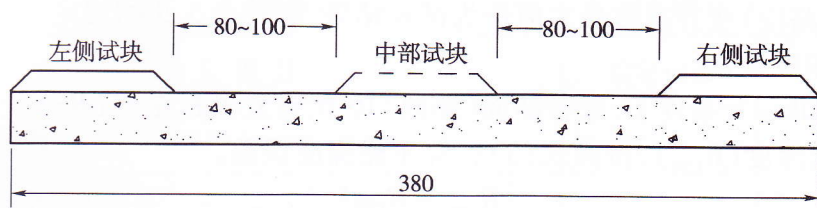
标准车辙试验组块横向布置图(尺寸单位:mm)
